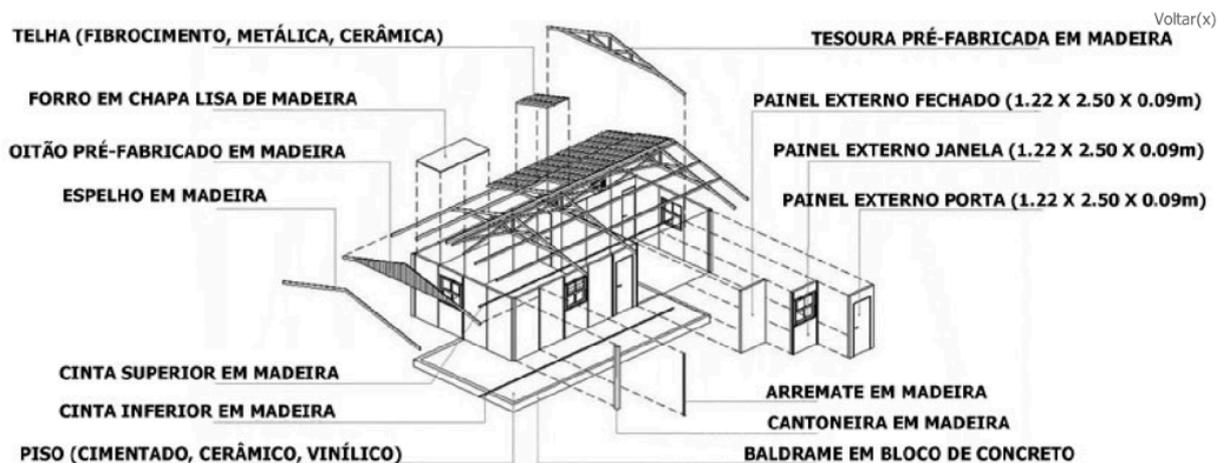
Sistema construtivo modular da empresa Canteiro. Fonte: (CANTEIRO, 2014)
